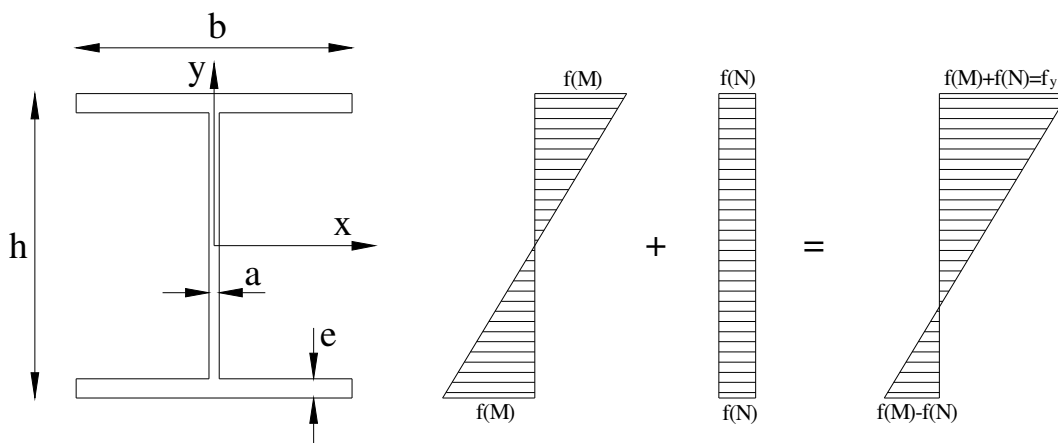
Tensioni della sezione nella condizione di snervamento.
